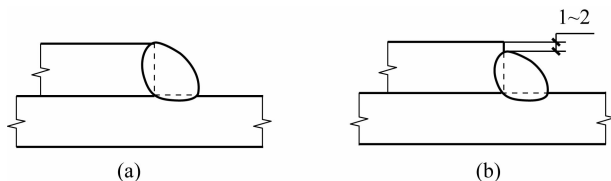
搭接焊缝沿母材棱边的最大焊脚尺寸
